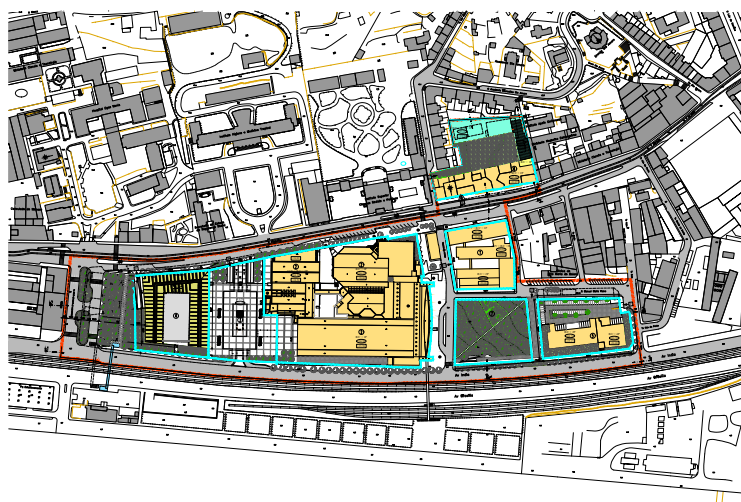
Planta do Plano de Pormenor do Centro de Congressos.
